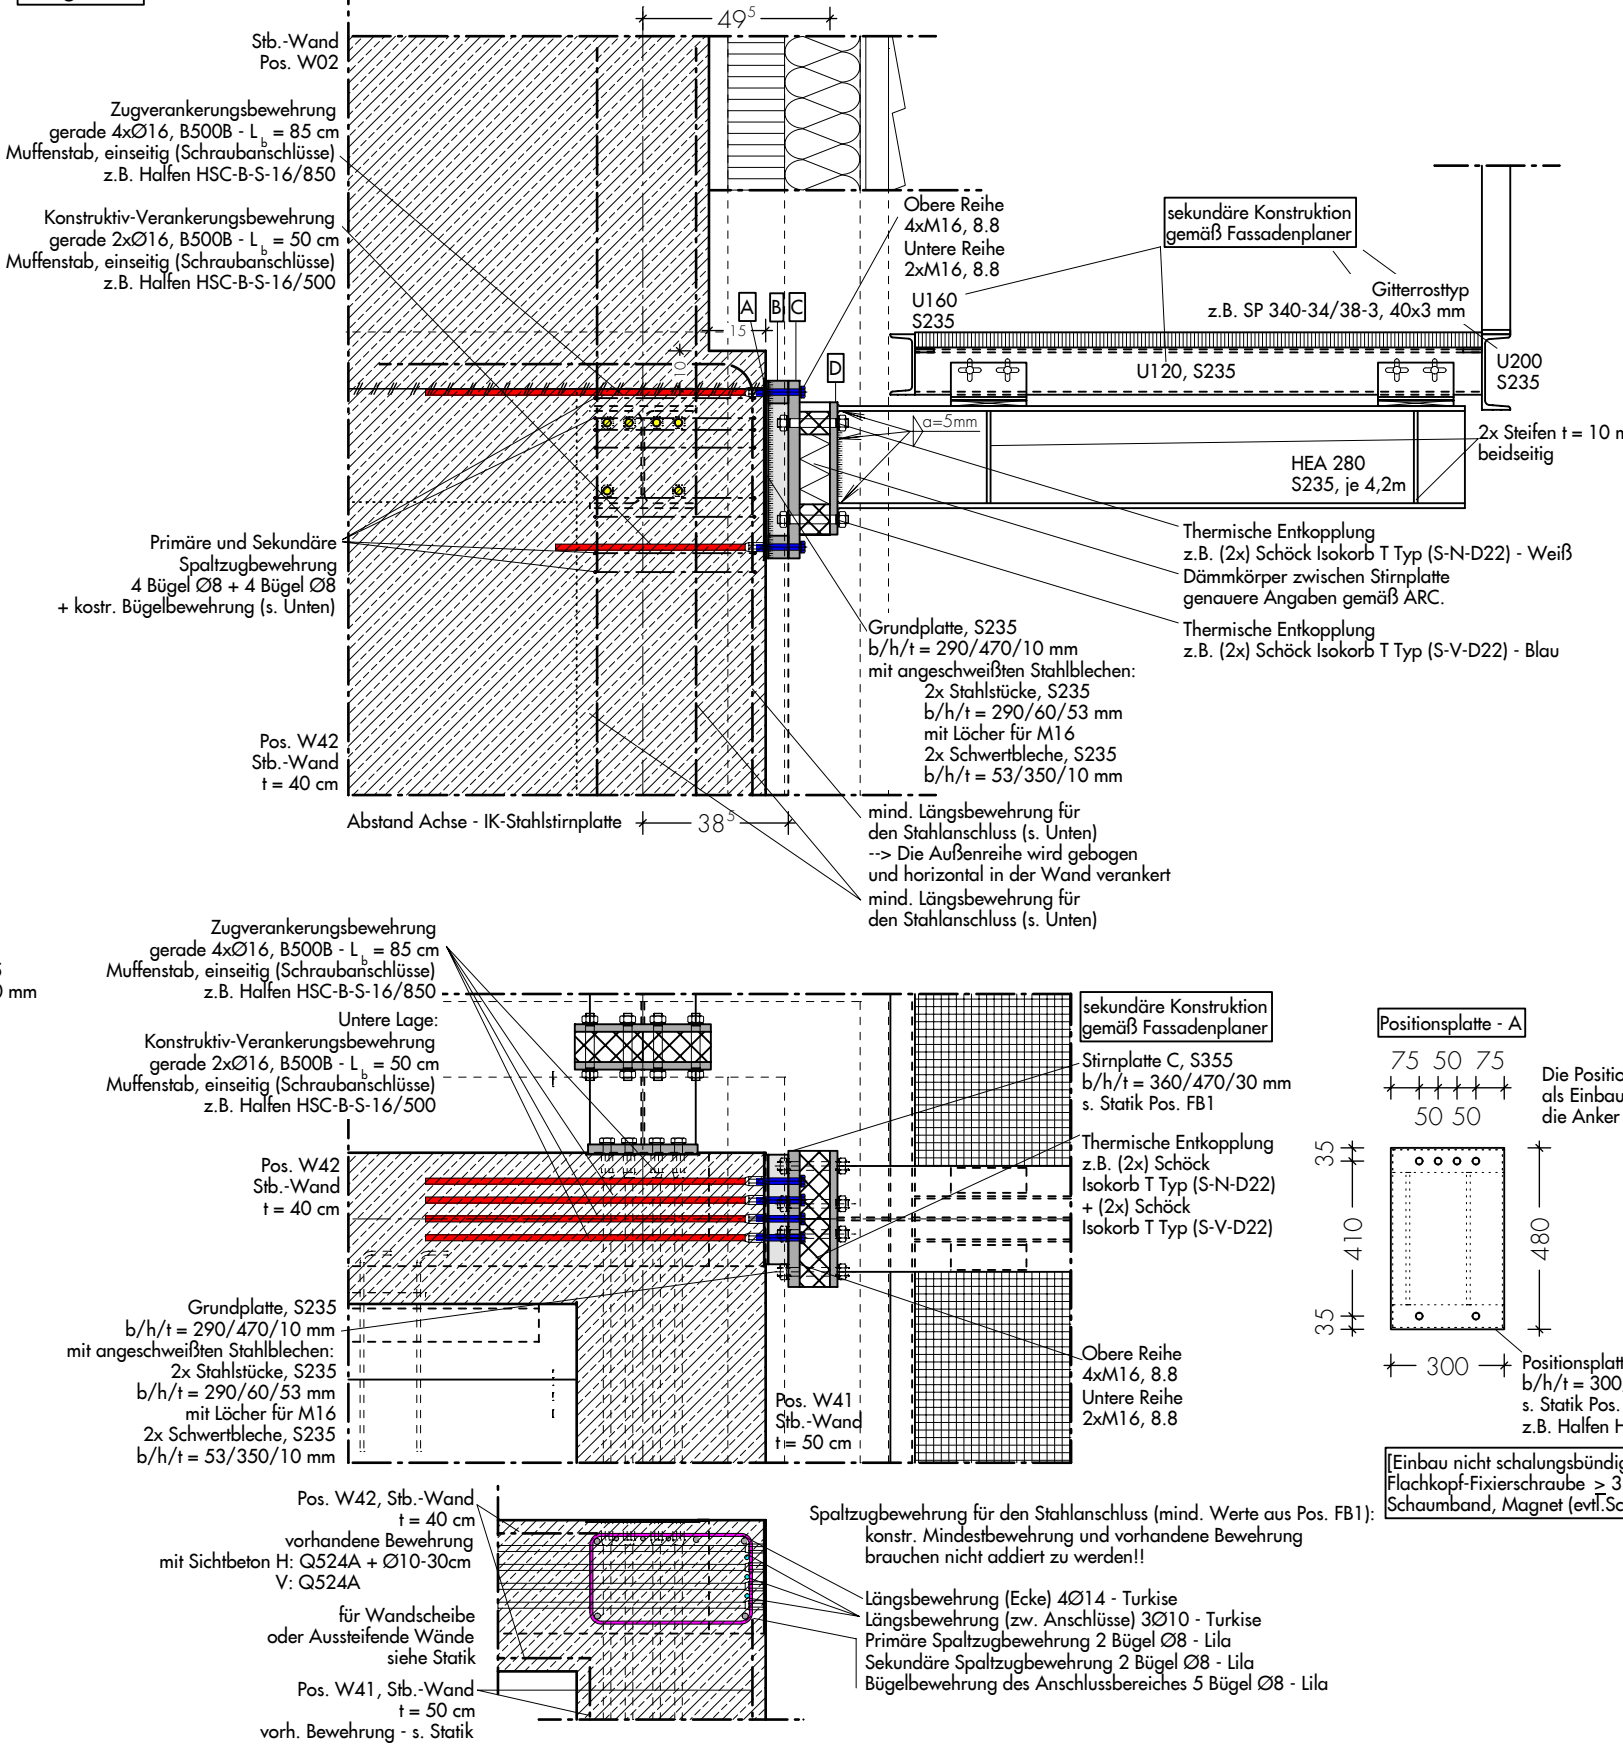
RG-5.1] : Stb.-Wand/Stahlbauanschluss/Therm. Entkopplung/Fluchtbalkon (EG)
